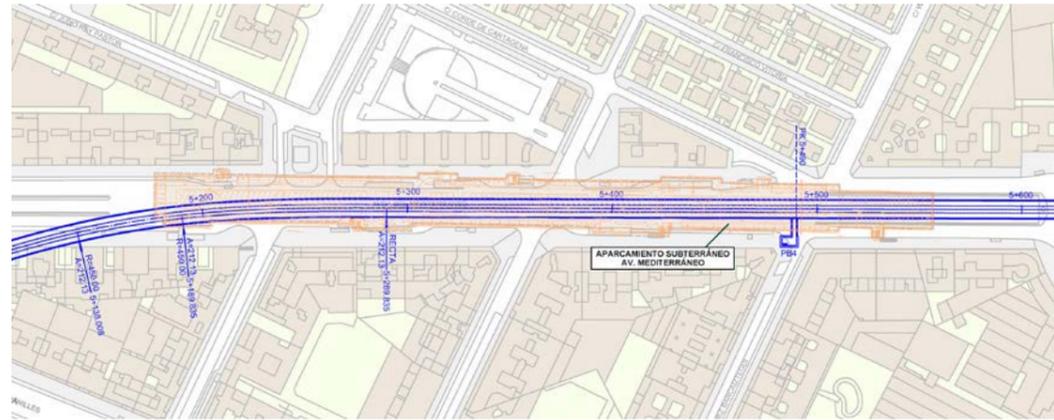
Planta del aparcamiento subterráneo situado en la Avenida del Mediterráneo
